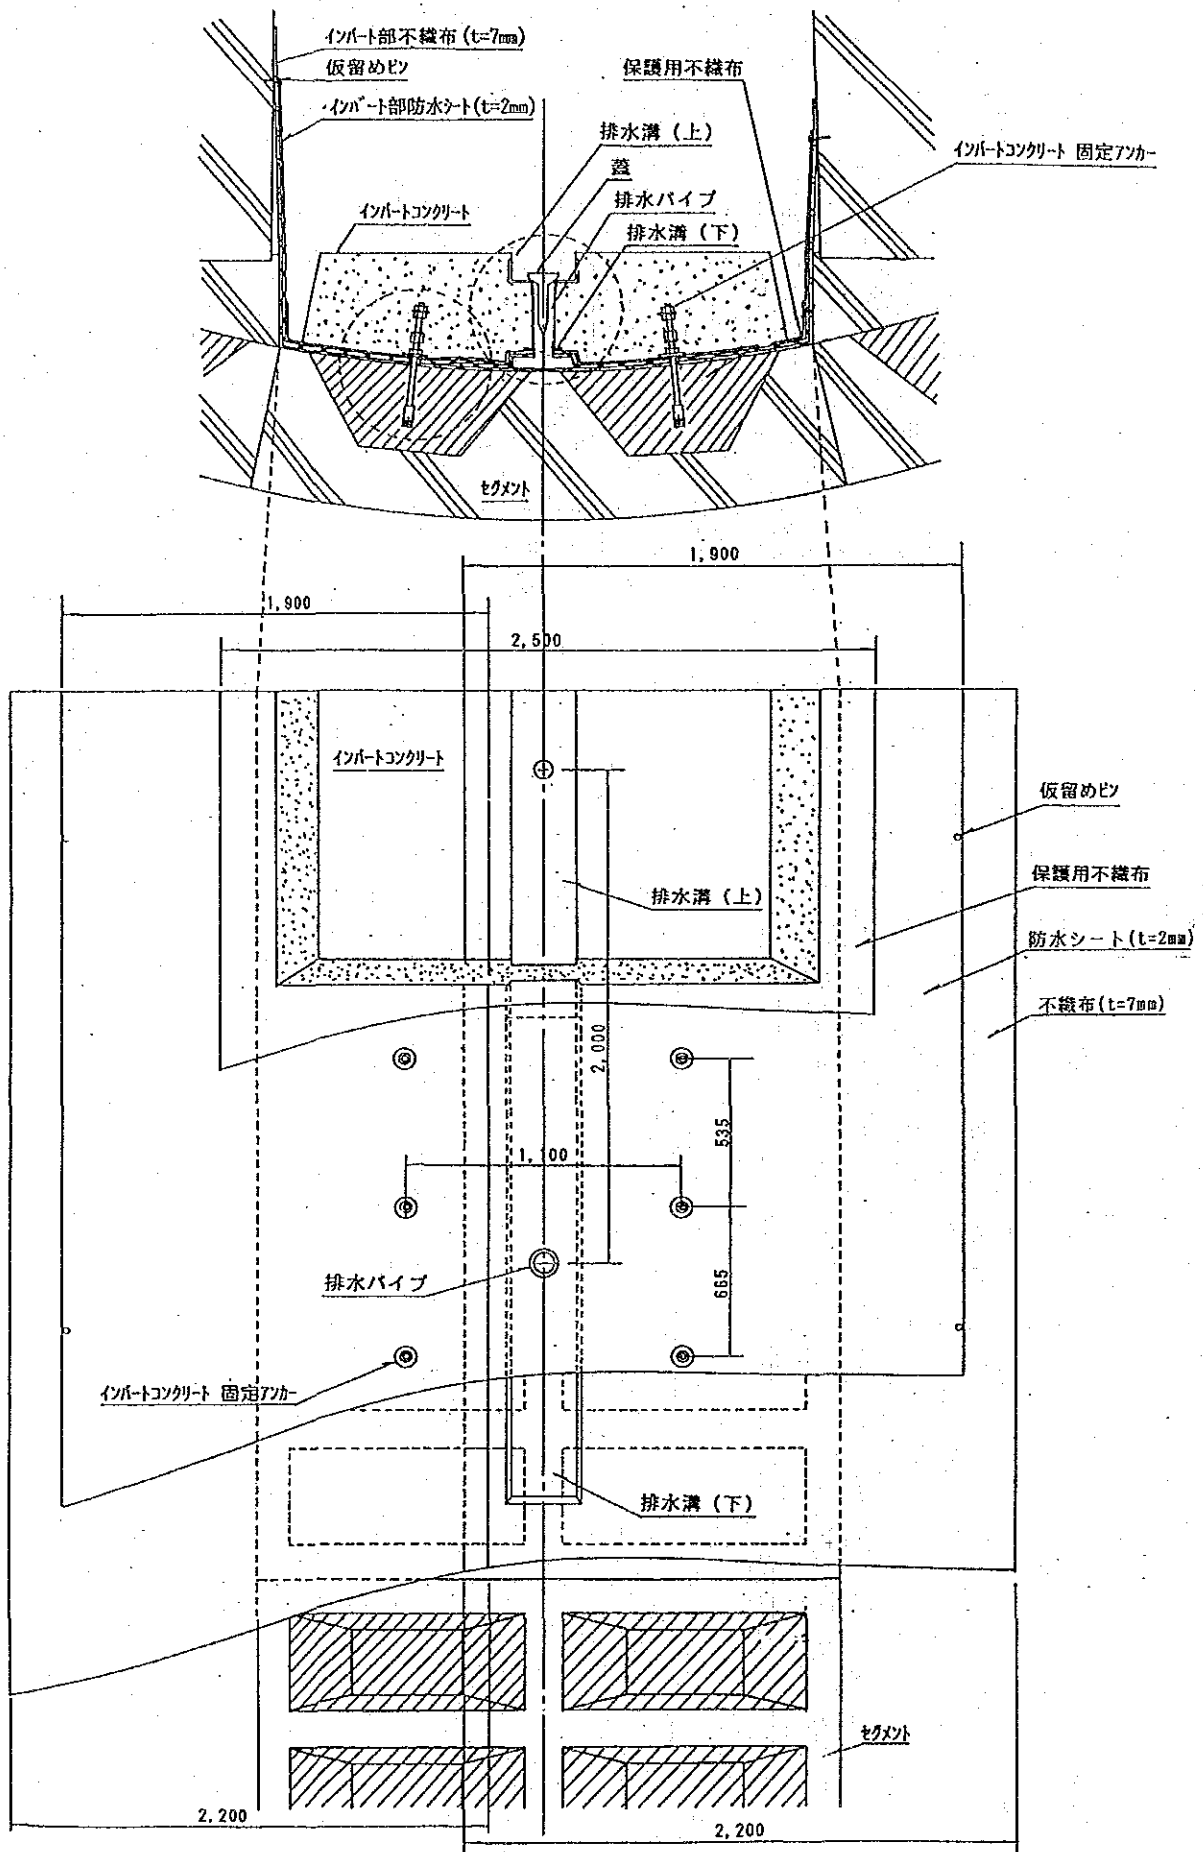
(3)-4 防水シート展開図 (インポートコンクリート施工時)
